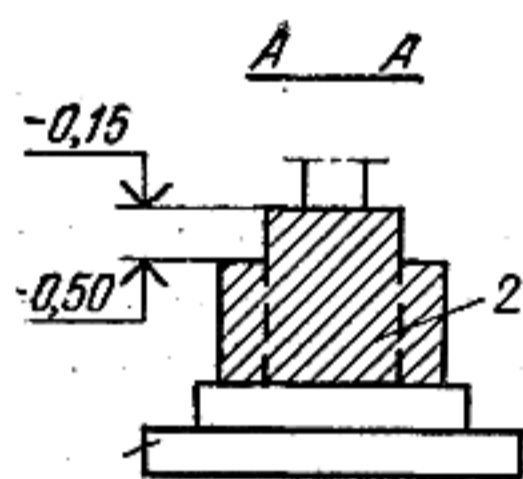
Фундамент с подбетонкой для опирания балок
